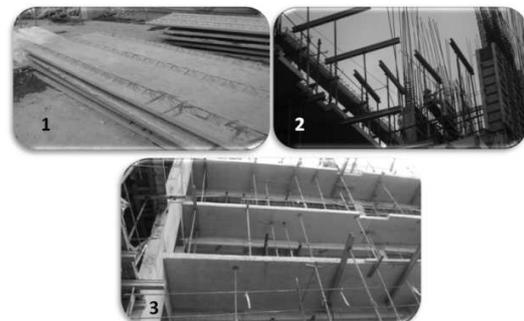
(1) Apilamiento de prelosas (2) Apuntado para prelosas (3) Colocación de prelosa y ajuste de puntales.
